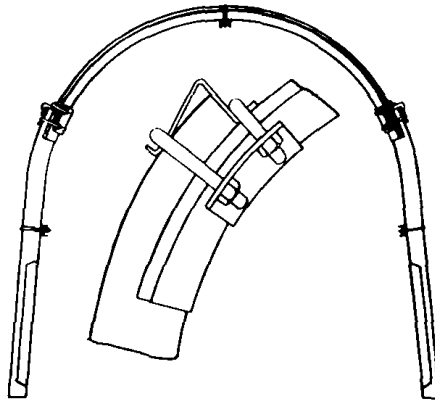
Железобетонная арочная податливая крепь КЖК-У
